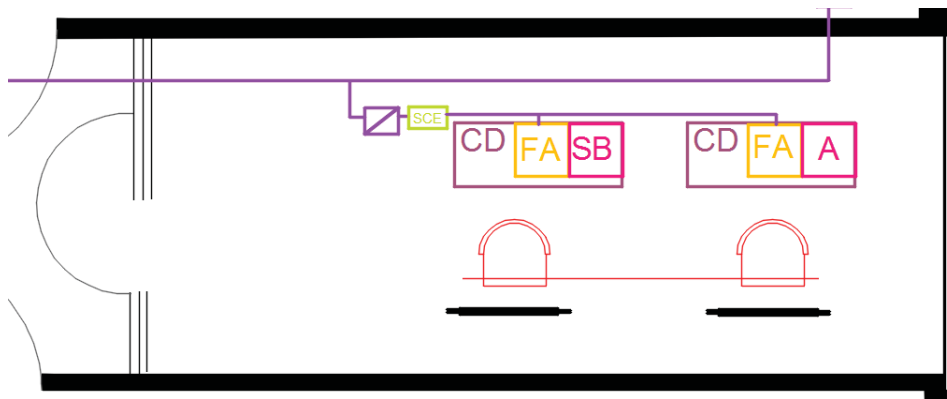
Corte plano Reingeniería Eléctrica área de gestión
